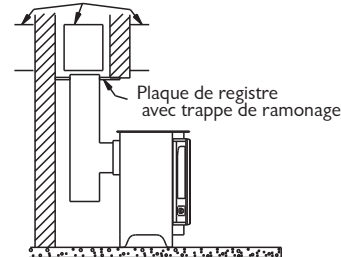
Plaque de registre horizontale avec branchement de conduit de fumée par l'arrière
